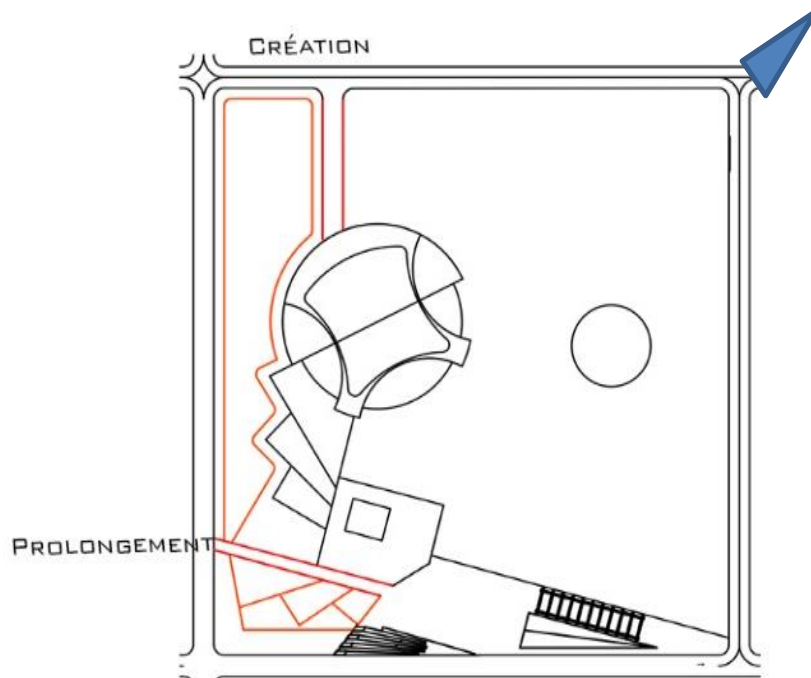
14: Plan de masse Opération 02 (marquée / espace vert / plan d'eau).
